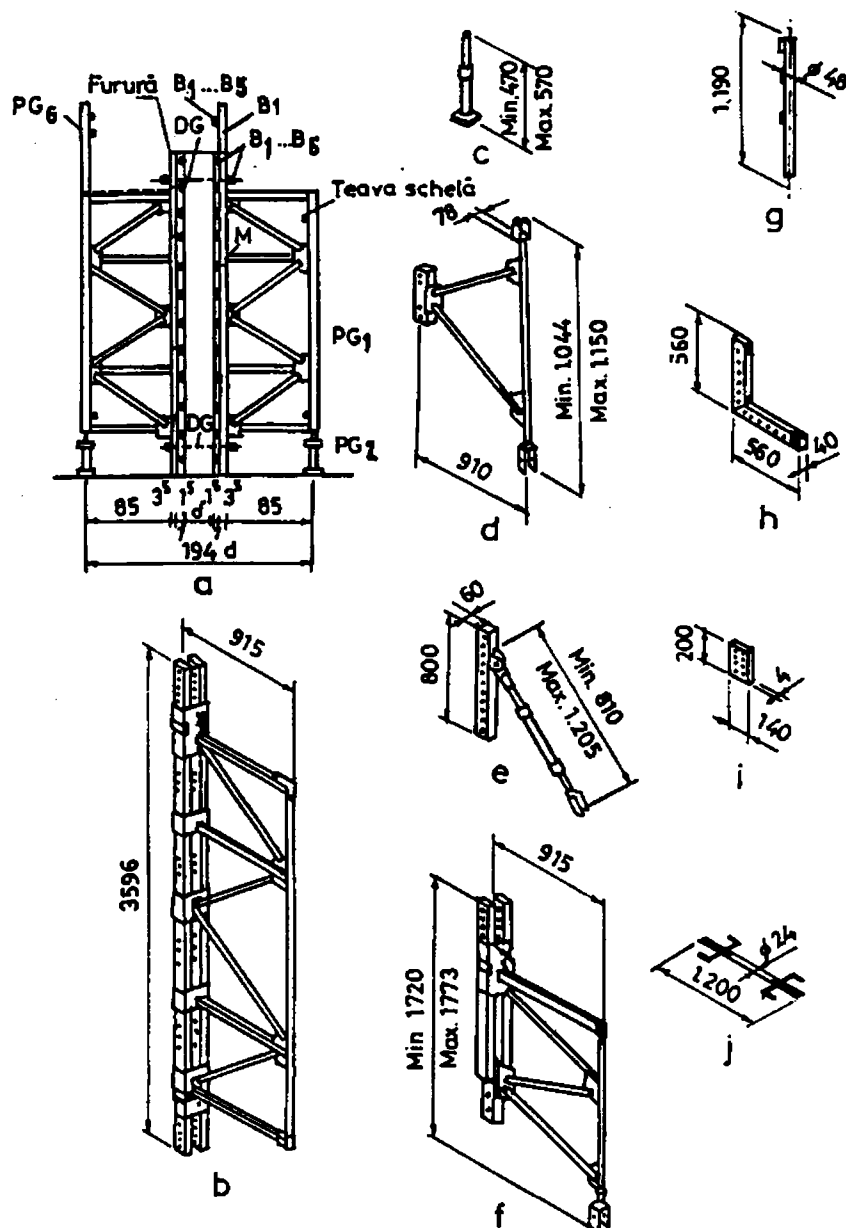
Elemente componente ale cofrajului mixt greu (CMG):
